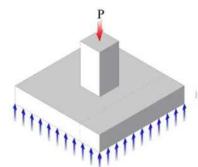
Zapata Aislada. Fuente: Google (19/07/21)
